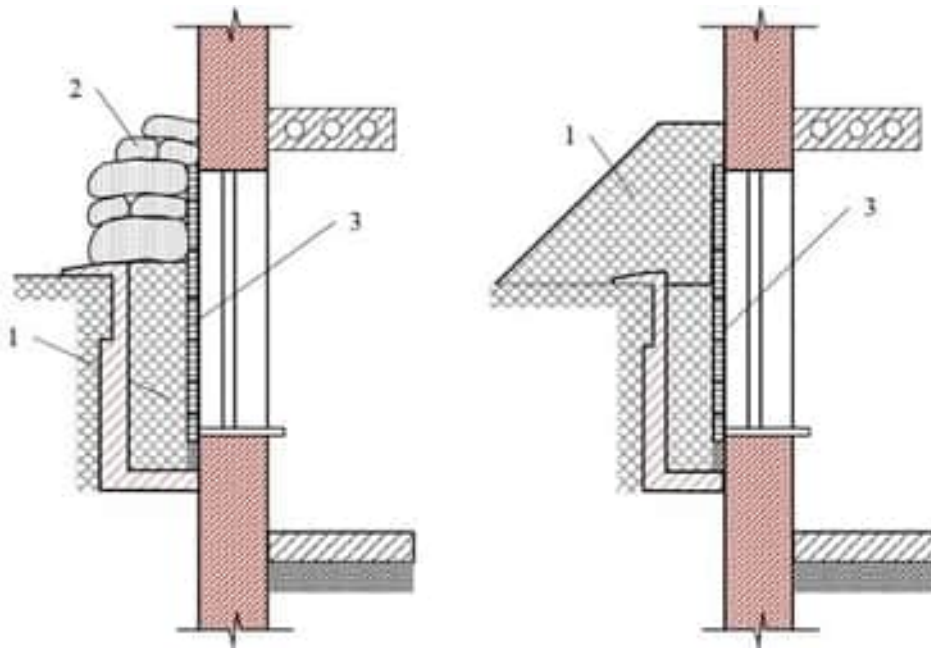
Захист стін цокольного поверху, що виступають над поверхнею землі: 1 – ґрунт; 2 – мішки з ґрунтом; 3 - дерев'яний щит, що перекриває віконний проріз
